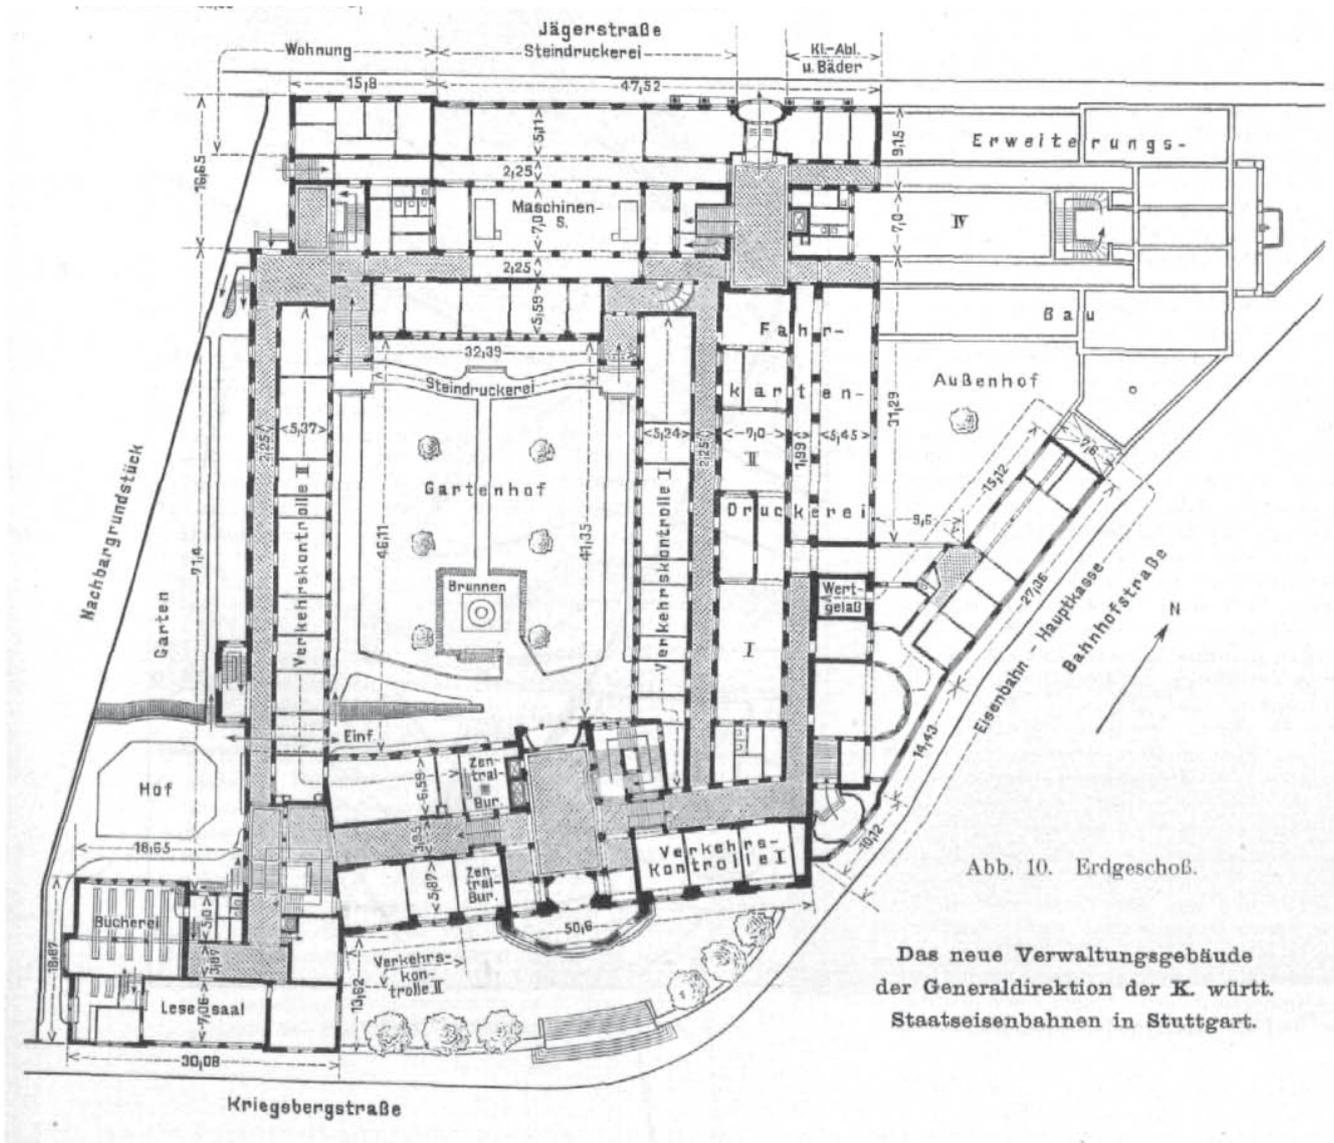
"Alte Bahndirektion", Lageplan /Grundriss von 1914
